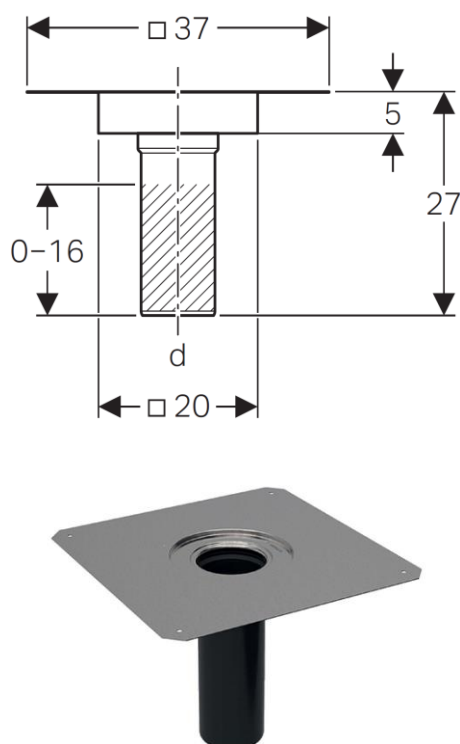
Geberit Pluvia aansluitelement dampscherm, met dichtingsplaat, voor Geberit Pluvia trechter 25 l/s (359.102.00.1)
